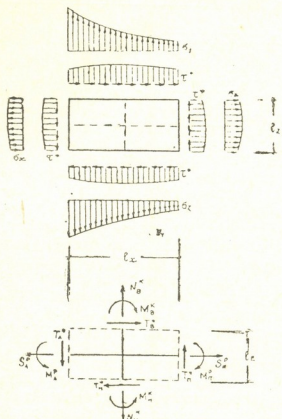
Схемы для определения усилий в элементах внутренних узлов рамы каркасных зданий по найденным напряжениям в приведенной континуальной системе: а) эпюры найденных напряжений; б) усилия в элементах i -го узла каркаса
